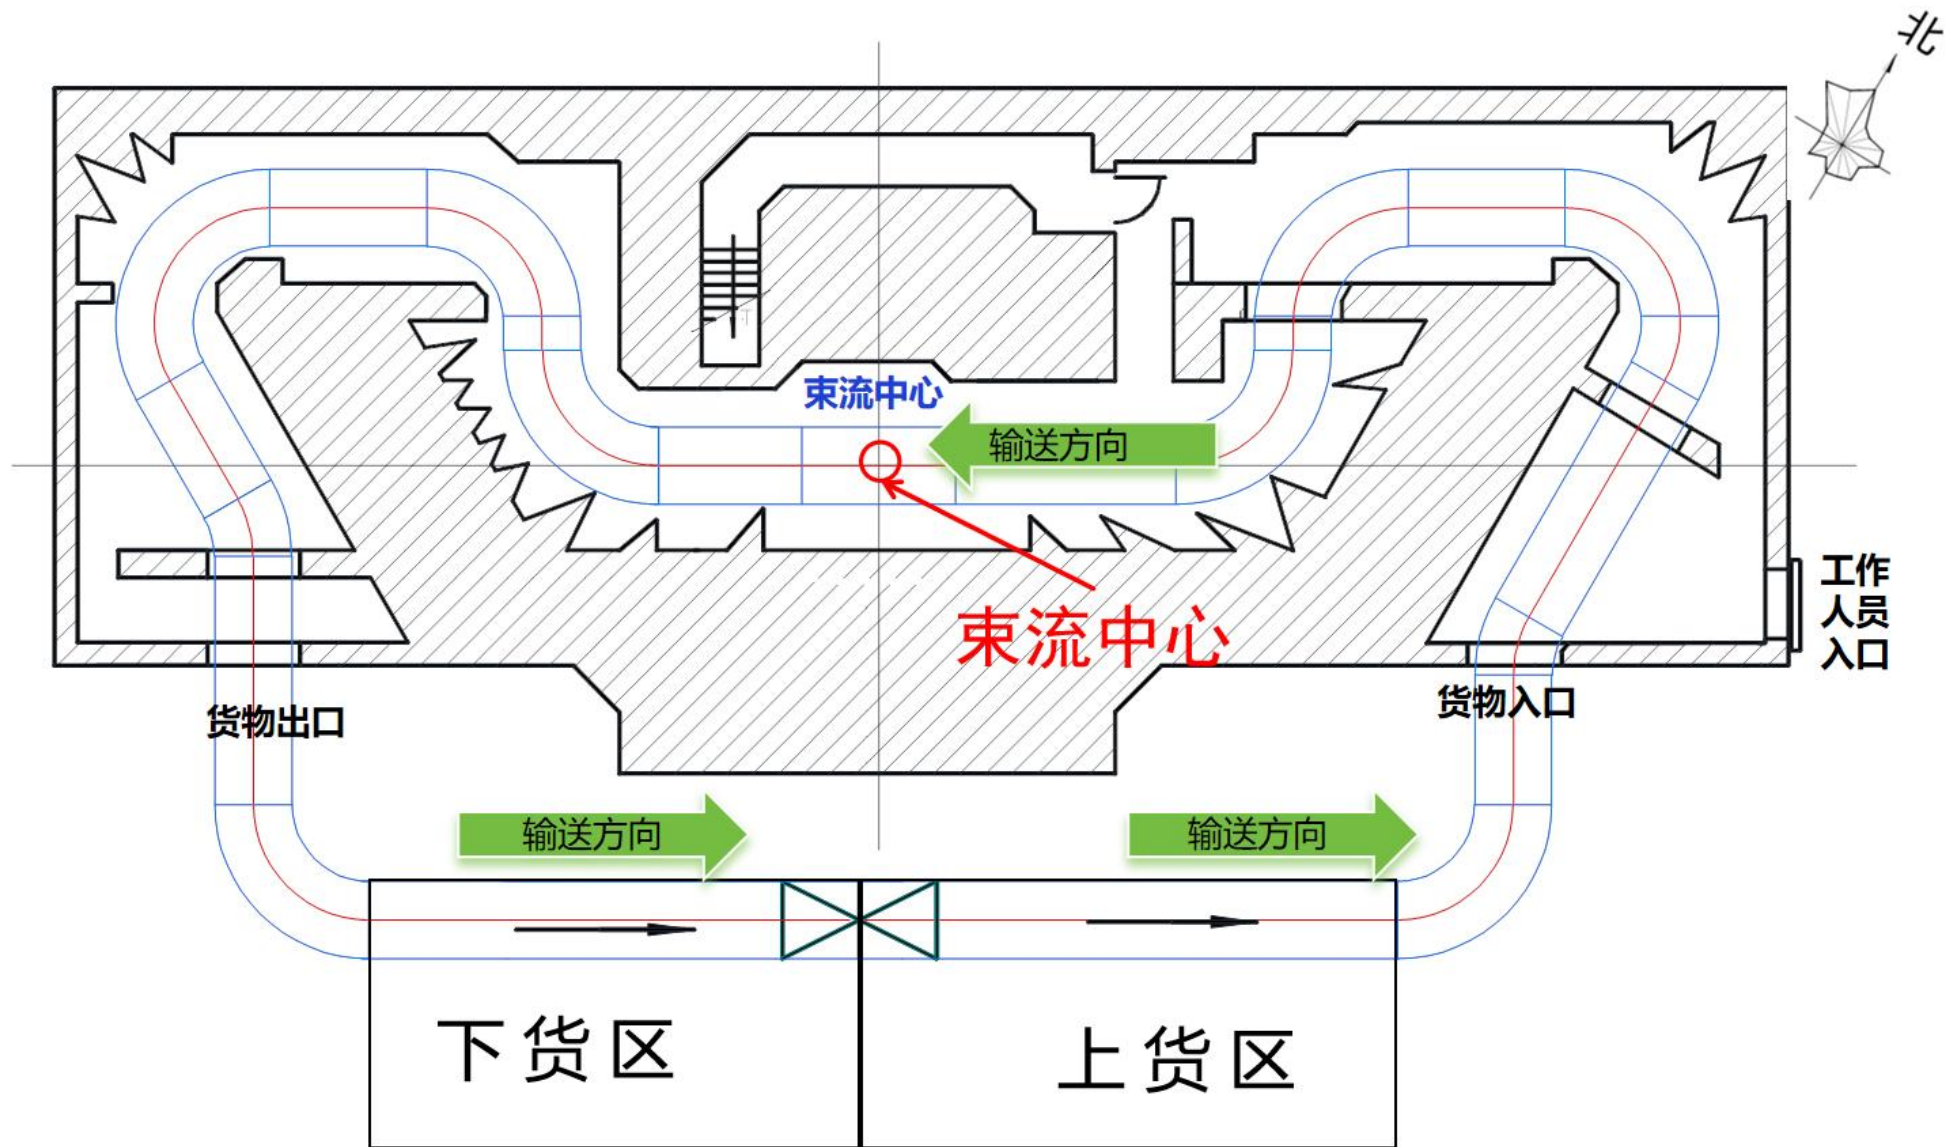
(2) 本项目加速器机房地上一层 (辐照室) 平面布置图
